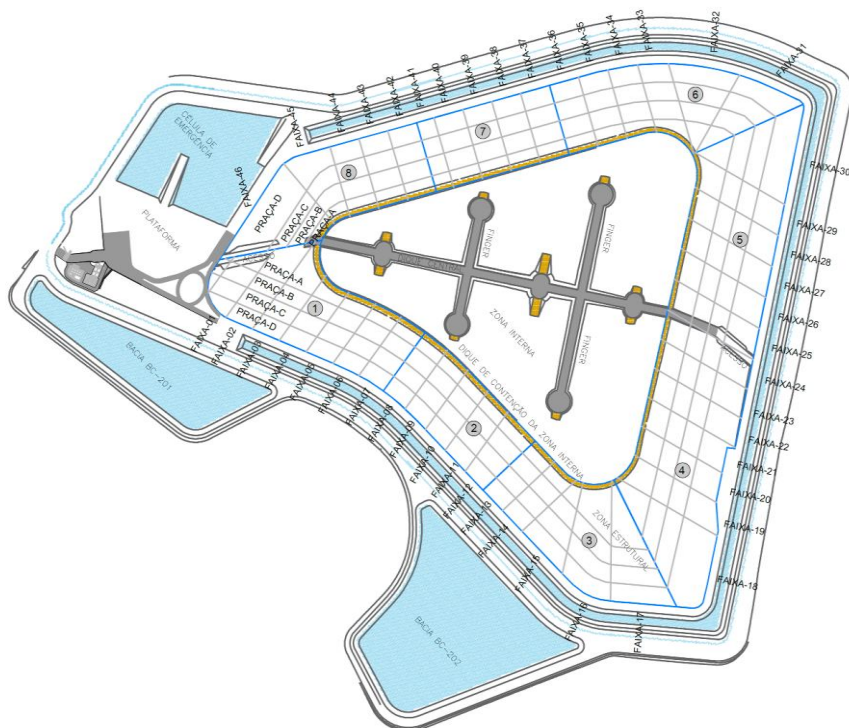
Setorização da Zona Estrutural em faixas e praças (Fonte: OM-3541-54-G-282 R08)
